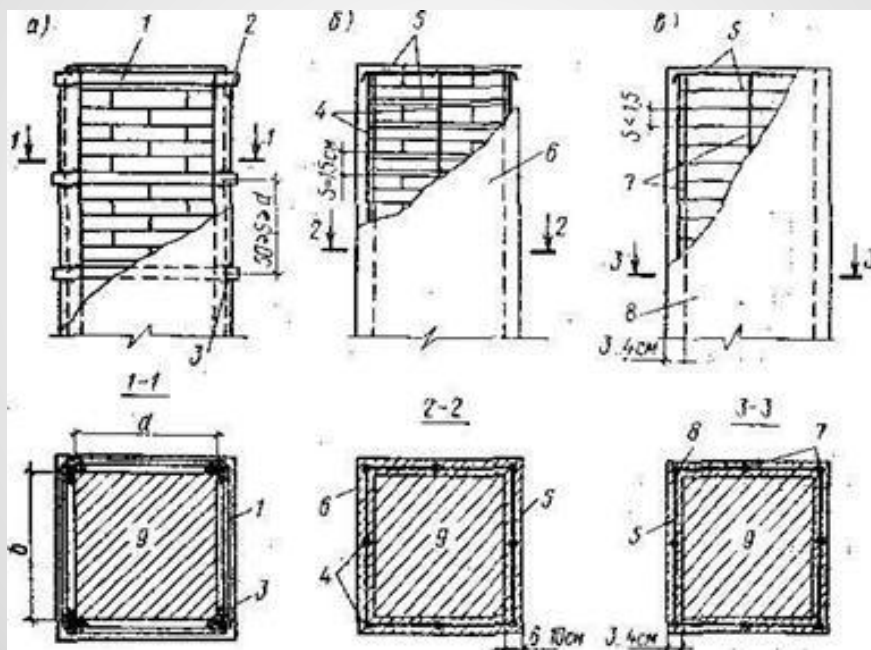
Усиление каменных столбов стальной (а), железобетонной (б) и армированной растворной (в) обоймами:
